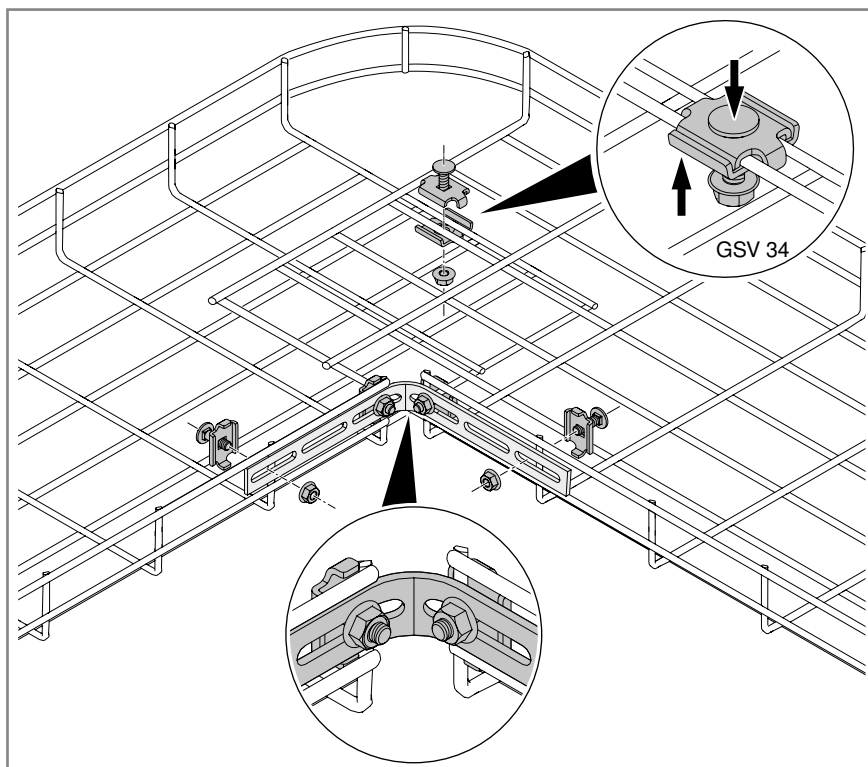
Монтаж стальной ленты с прорезями и стыкового соединителя GSV 34
